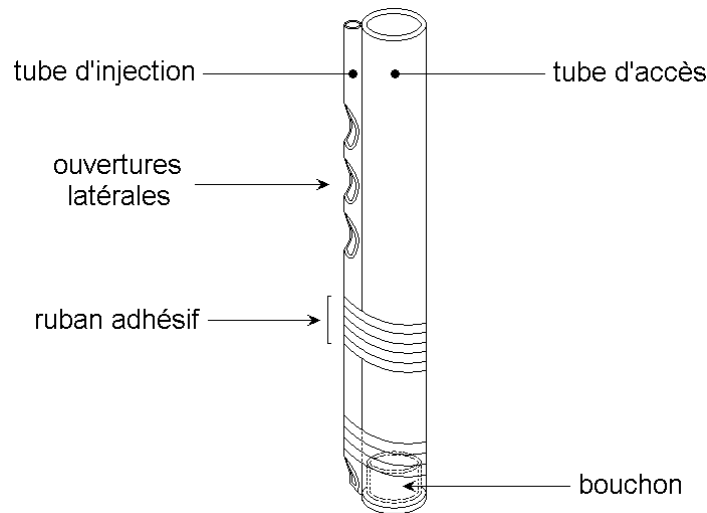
Détail du tube d'injection au bout du tube d'accès
